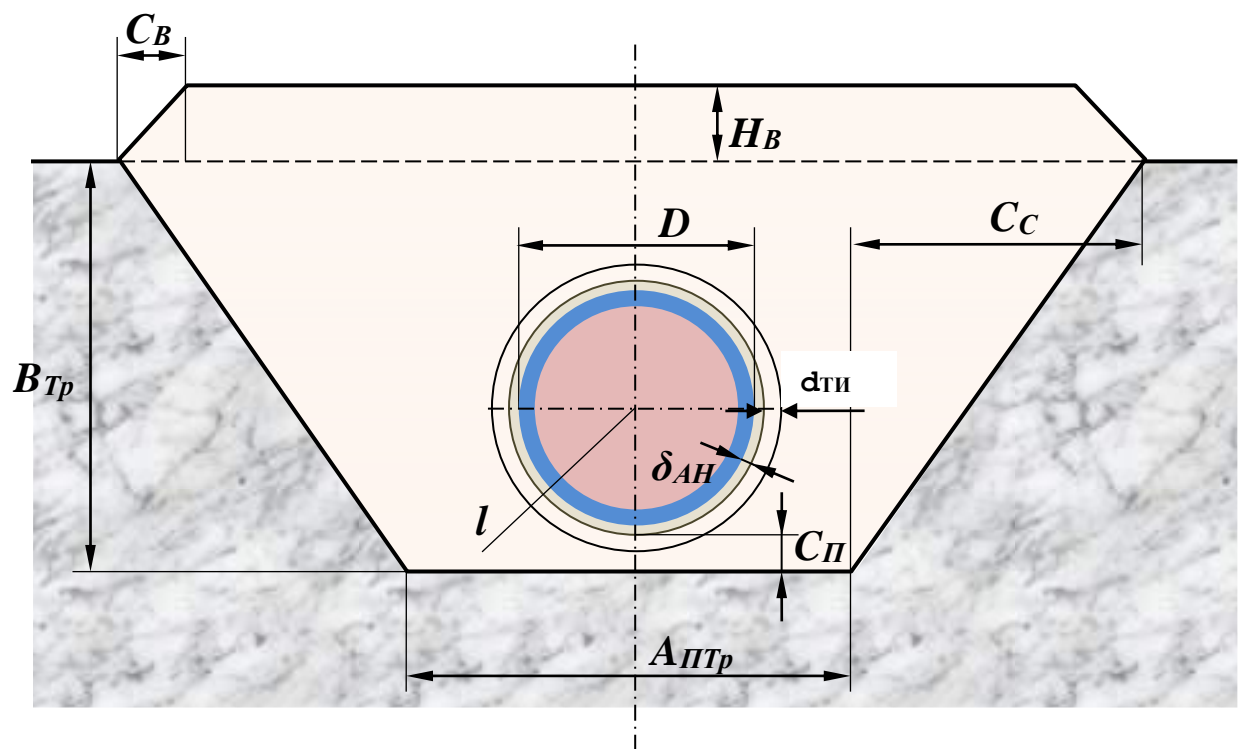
Расчетная схема поперечного сечения нефтепровода:
